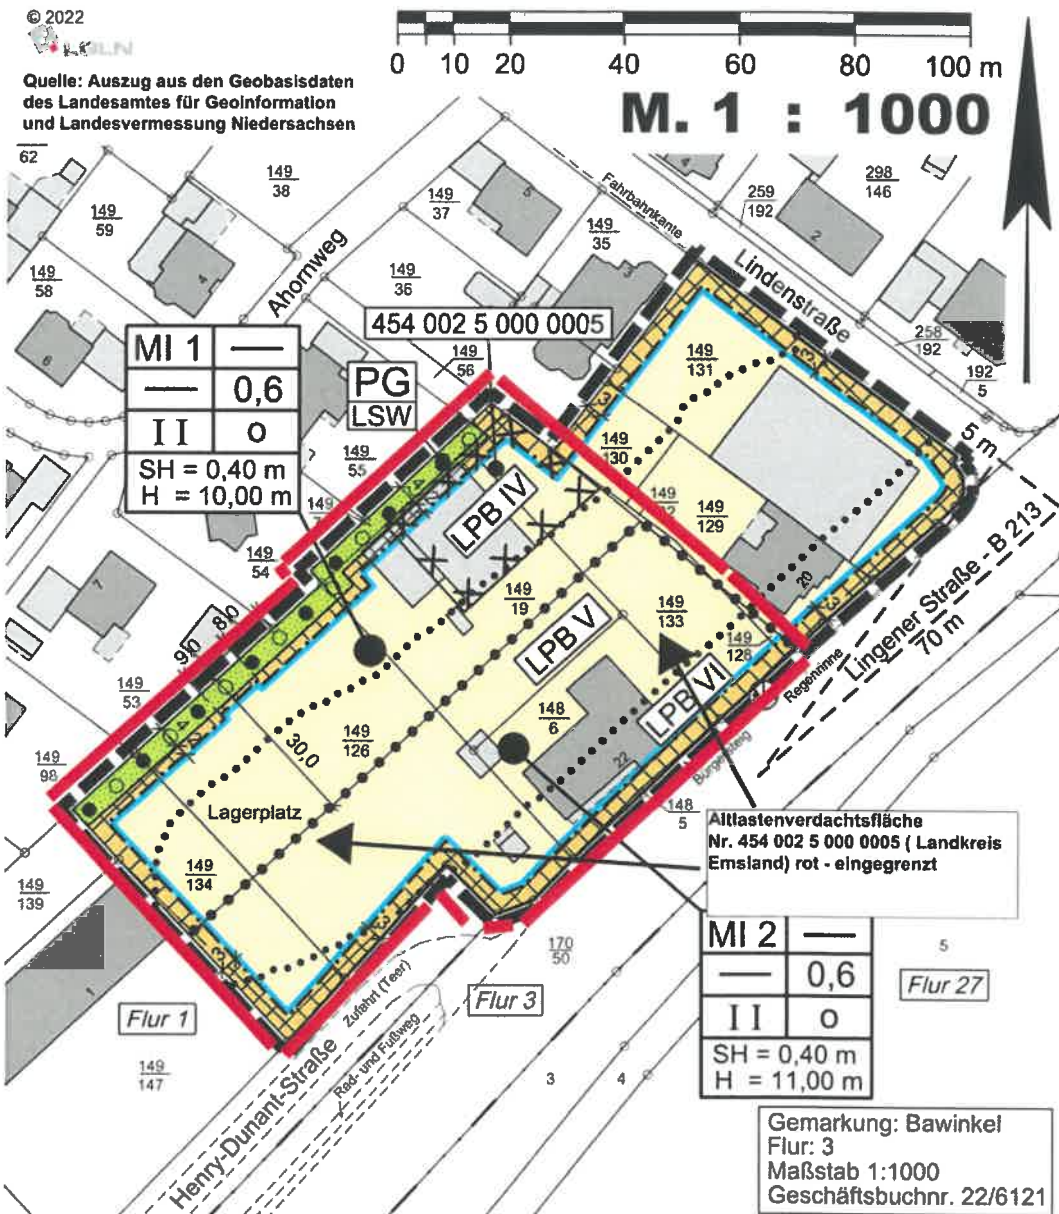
B-Plan Entwurf Nr. 44 mit Lage der Altlastenverdachtsfläche
